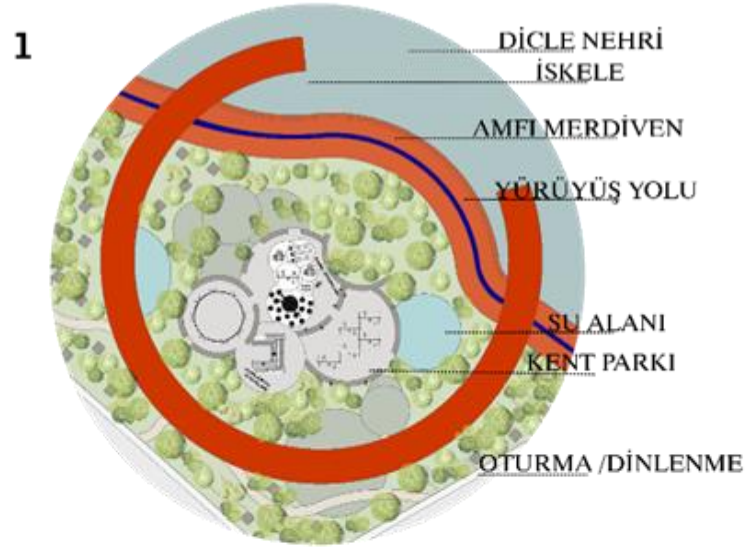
Meydan mahallesi tasarım projesi vaziyet planı
